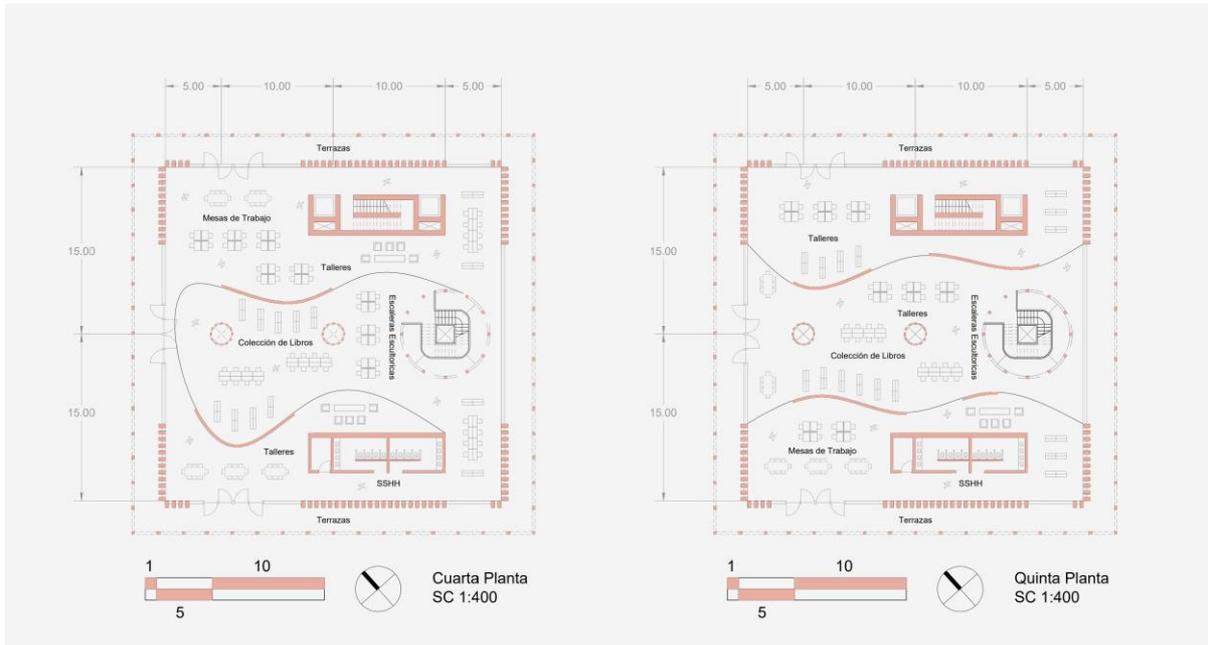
Tec. 4ta & 5ta Planta. Elaboración Propia
